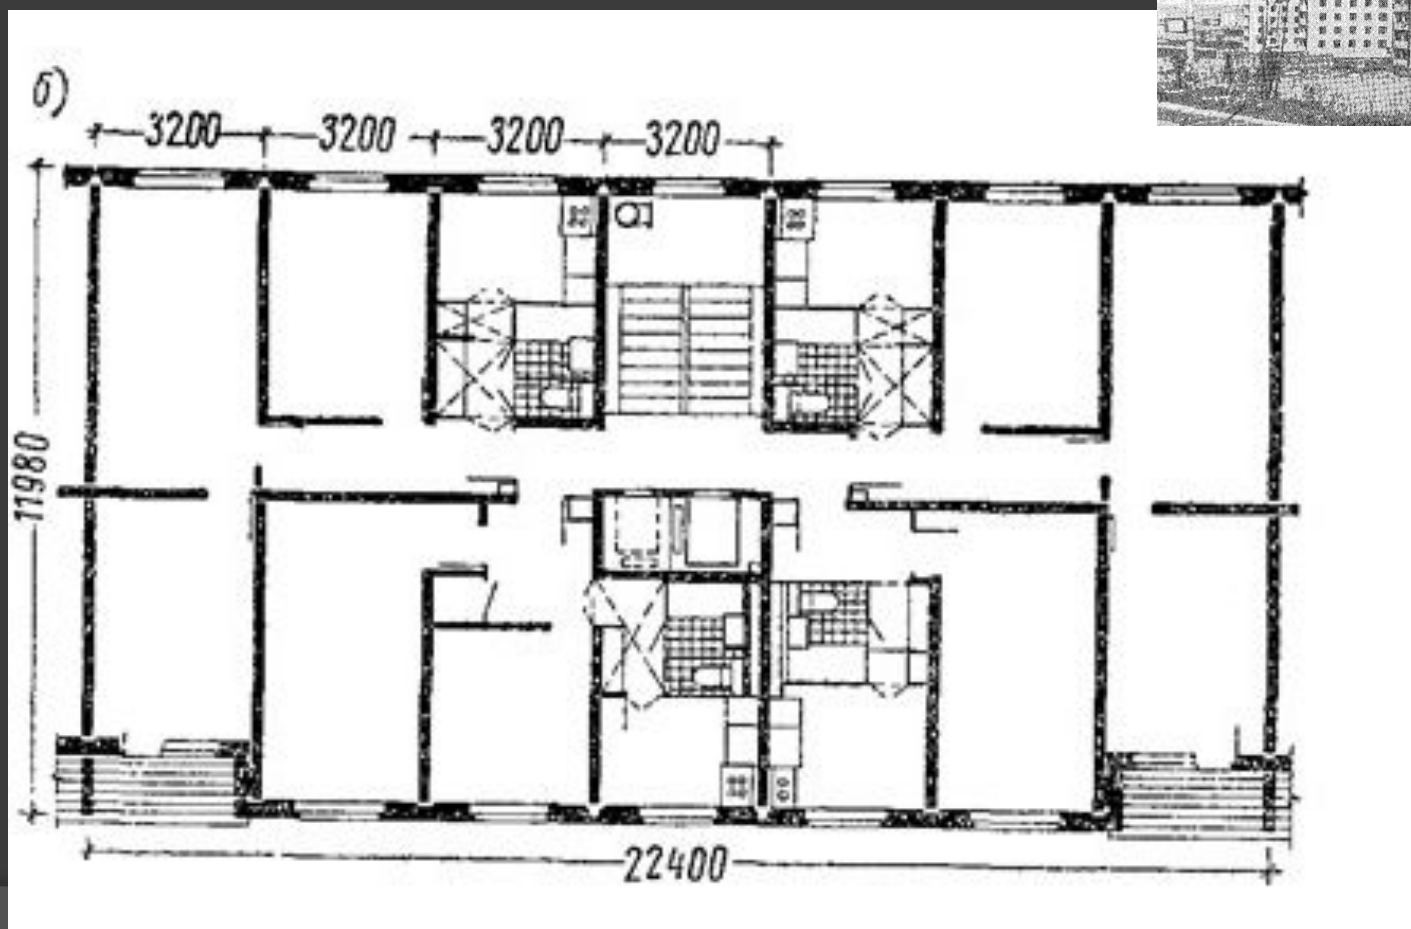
Крупнопанельный жилой дом с несущими продольными стенами серии 1-515. План типового этажа
